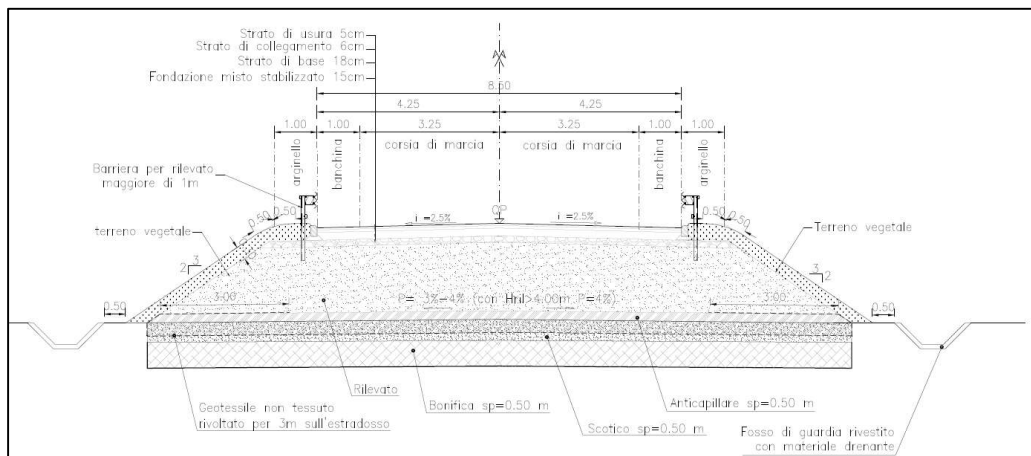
NV03 - Sezione tipo in rilevato (rettifilo)
